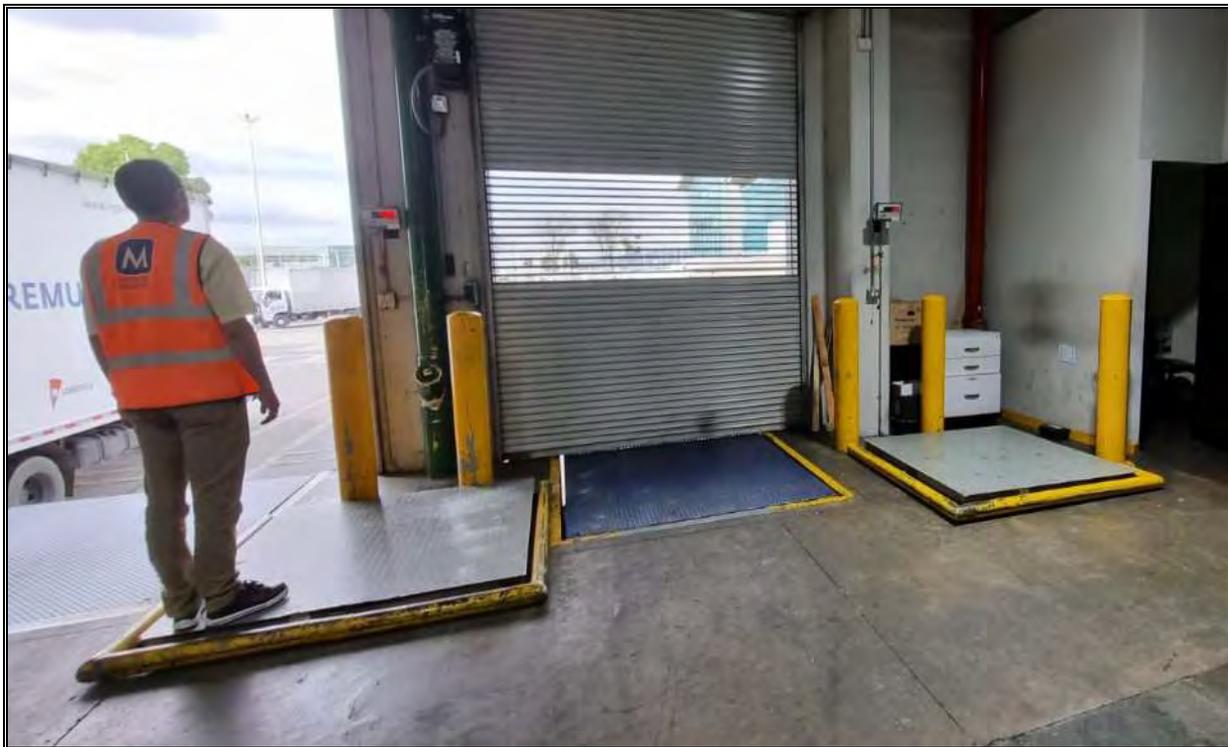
Vista de las puertas de salida de mercancía junto con las básculas de piso.
